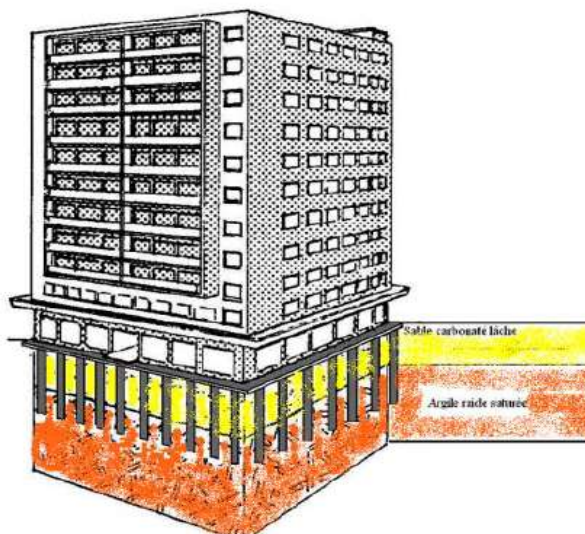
Exemple de fondation sur pieux supportant un bâtiment [1]
